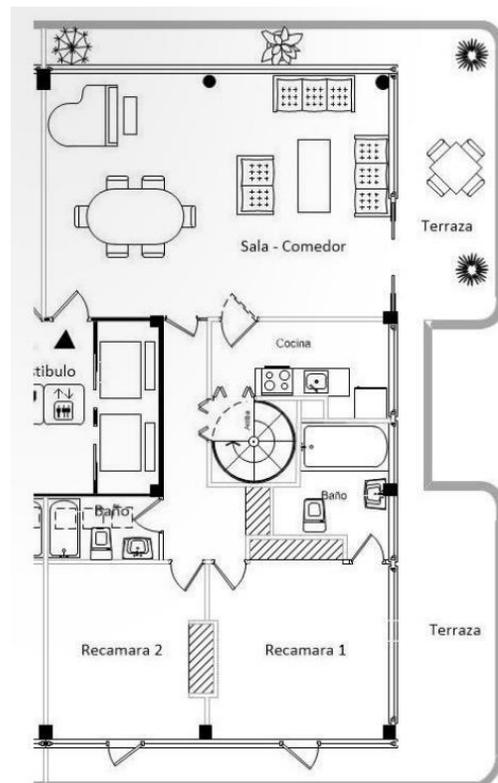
Penthouse tipo "M". Extraído de ArchDaily.
